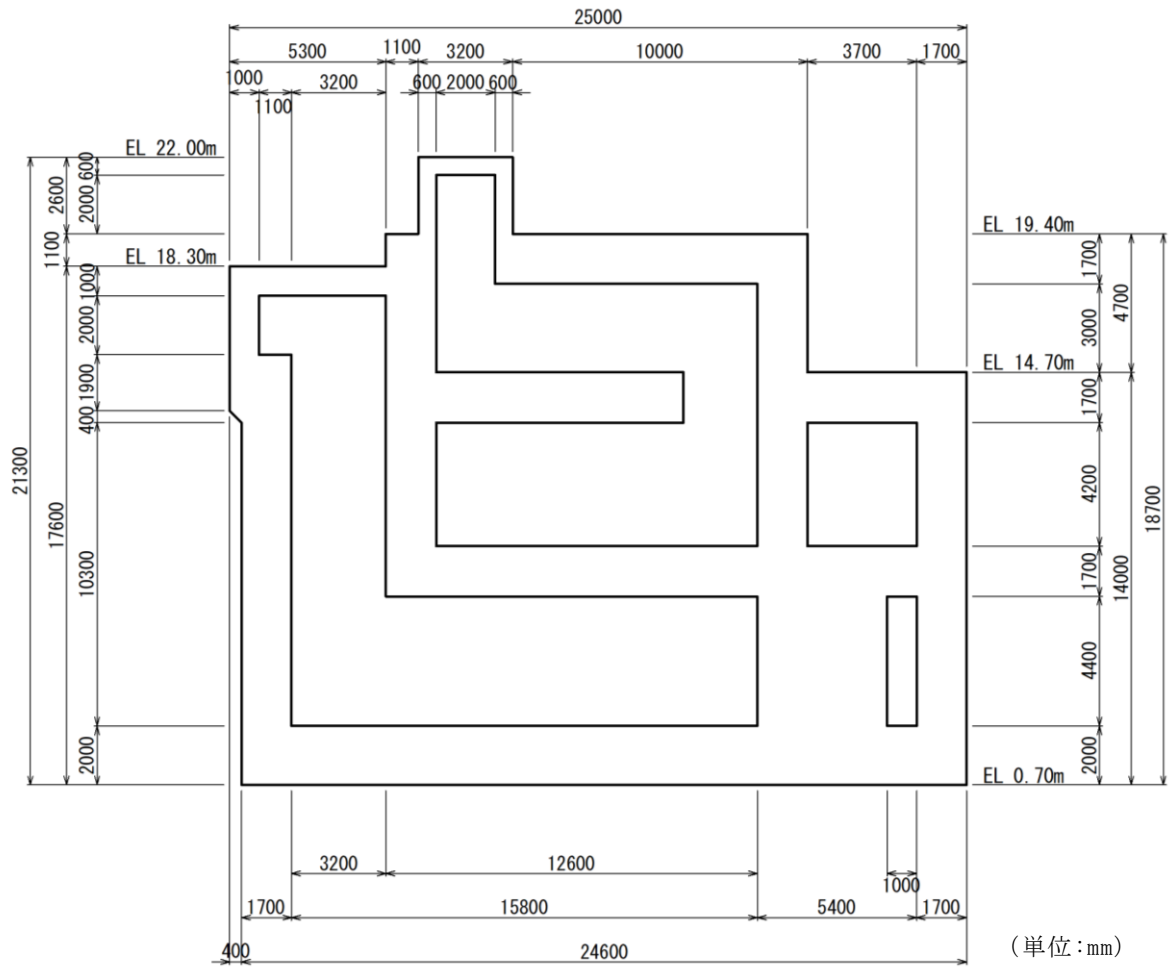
第 1 ベントフィルタ格納槽 断面図 (F-F 断面)
